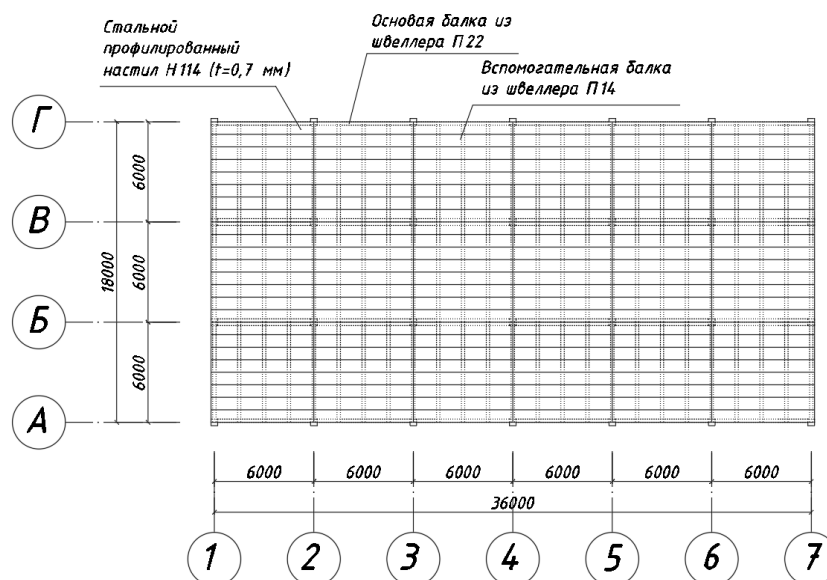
Вариант сборно-монолитного перекрытия по стальному профилированному настилу
